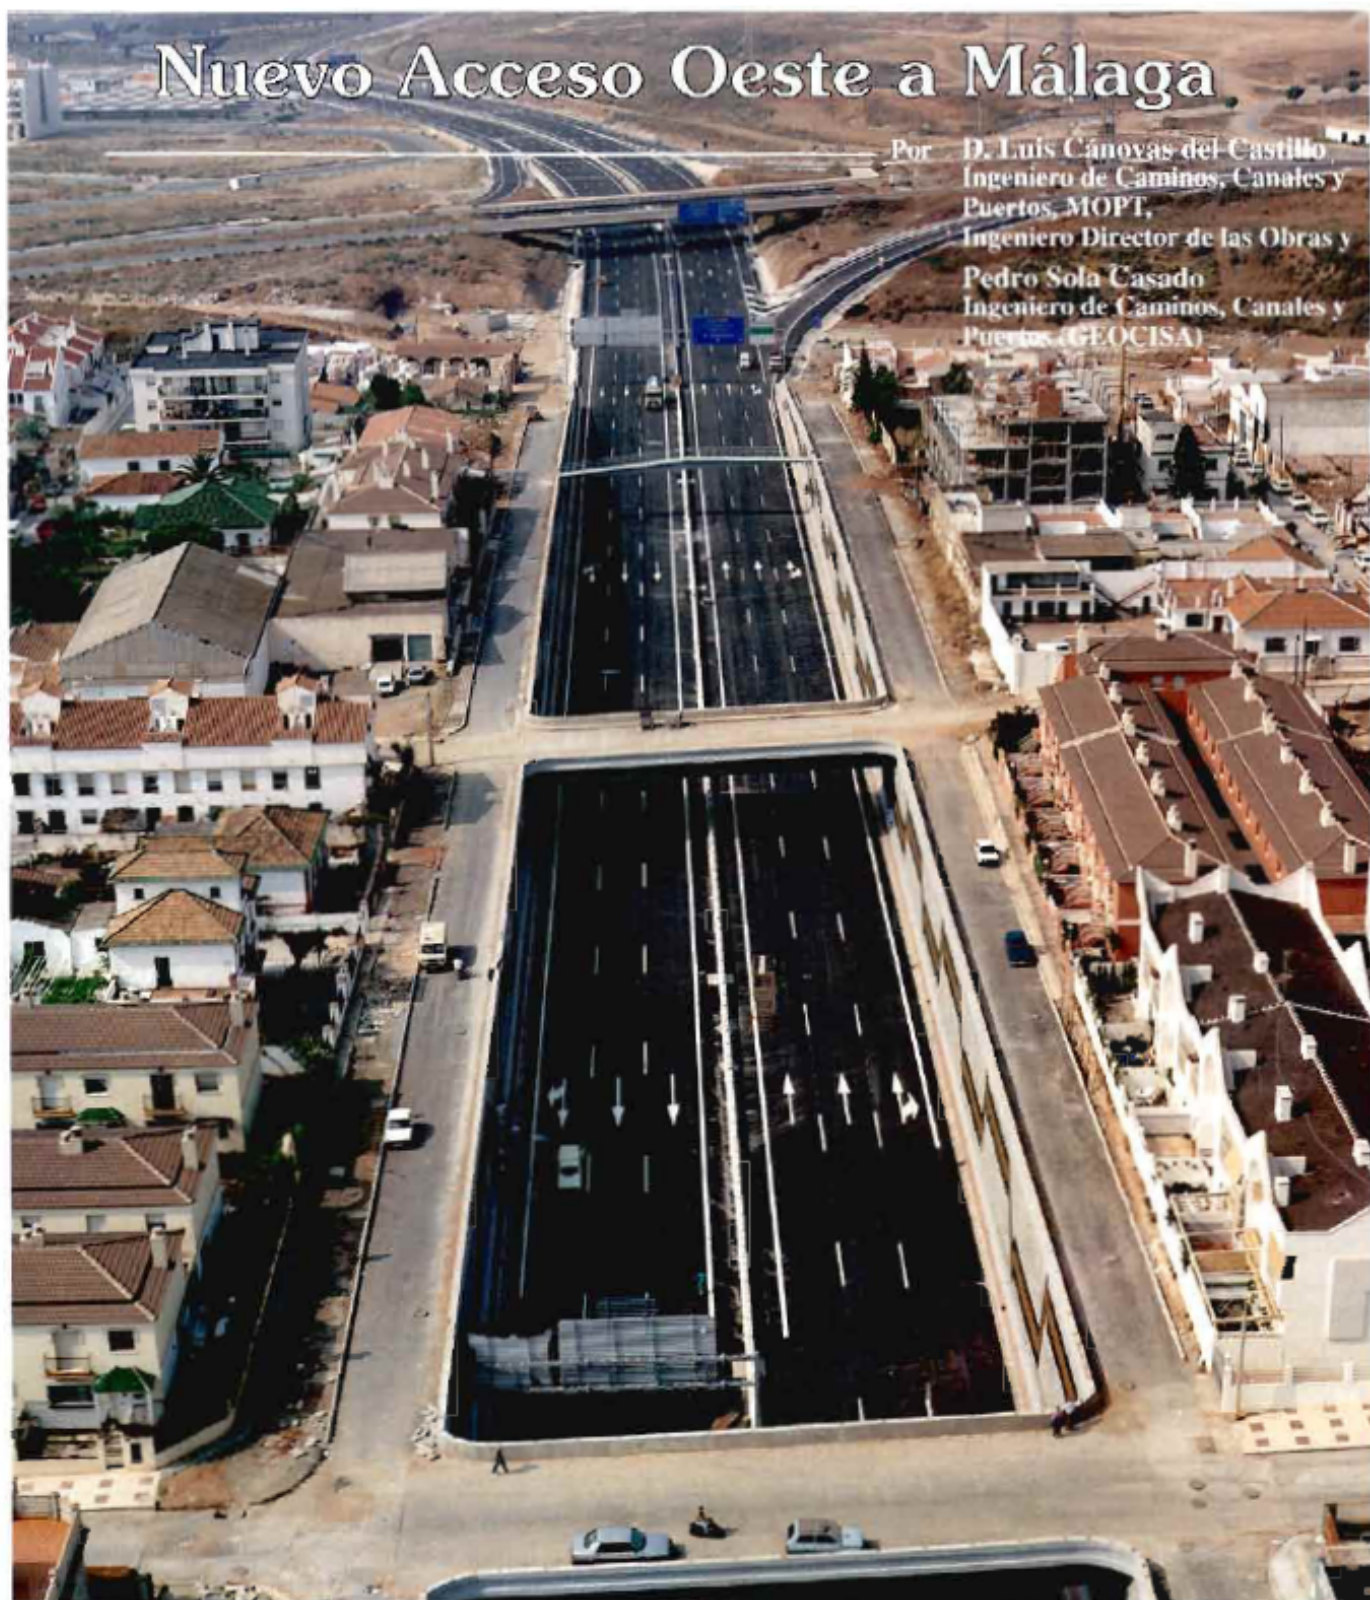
En ella, se aprecia una vista general de la zona entre muros pantalla.
